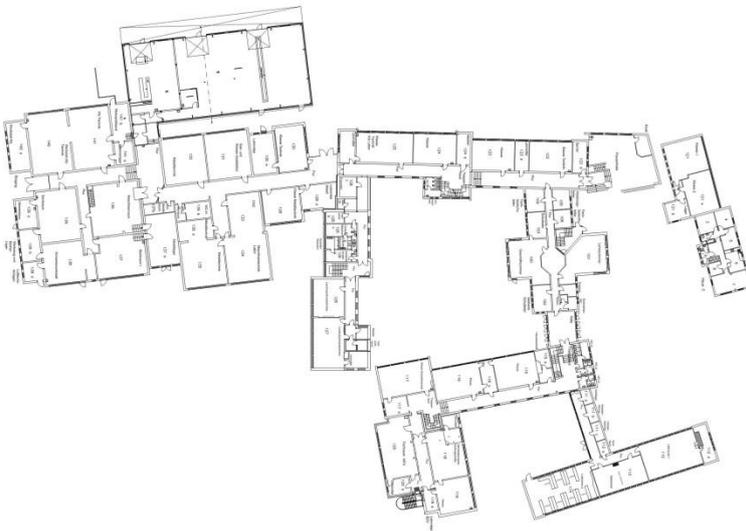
Grundriss Erdgeschoss Haus A des BBZ Bad Segeberg, Quelle: Gebäudemanagement Kreis Segeberg
